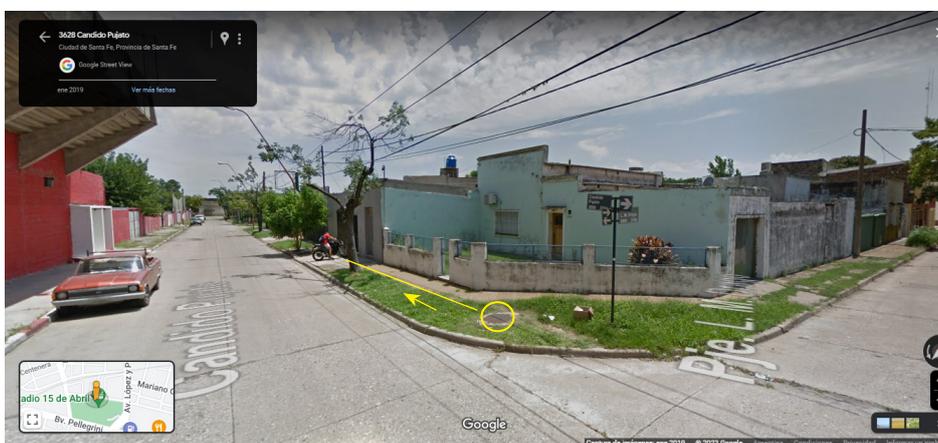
Fotografía en la intersección de calles Cándido Pujato y Pje. Drago (vista hacia el noroeste). En amarillo se esquematiza la traza del colector y su descarga hacia Avenida Perón.
